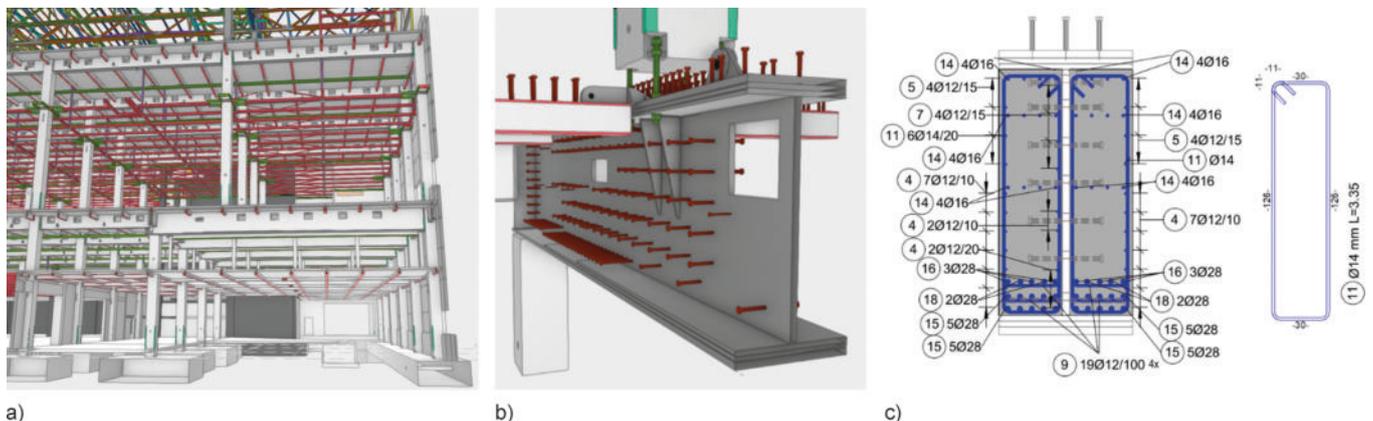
Querschnitt durch das Tragwerksmodell mit Logistikbahnhof (a), Abfangträger aus BIM-Modell (b) und Bewehrungsplan eines Abfangträgers (c)
